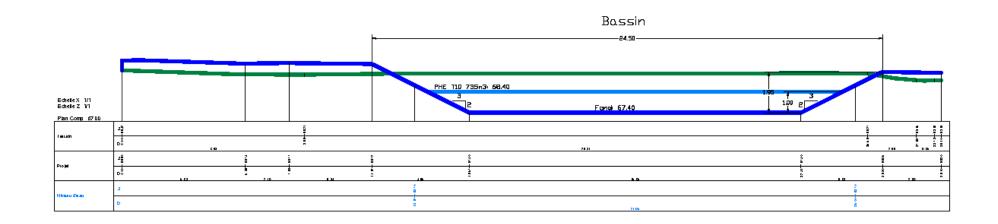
COUPE DU BASSIN DE RETENTION BV1
